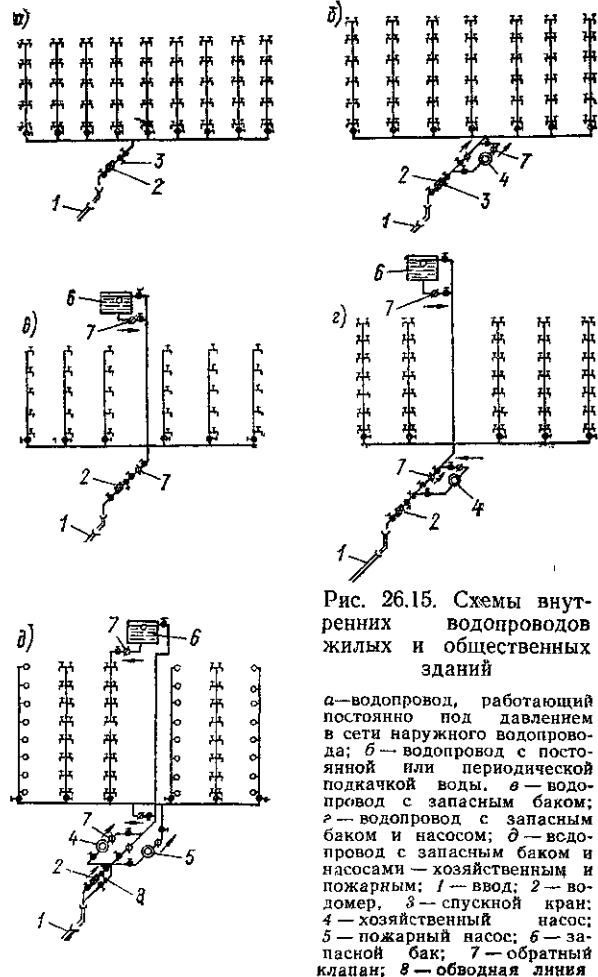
Схемы внутренних водопроводов жилых и общественных зданий
